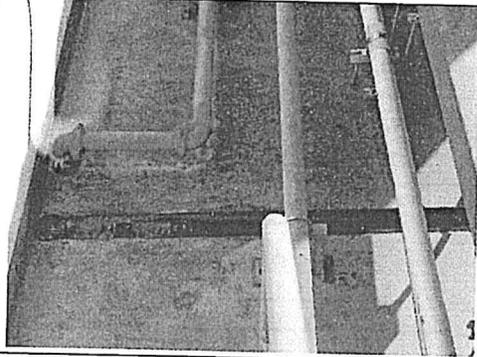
Inspección al sistema de drenaje pluvial del bloque A1 y A2.
